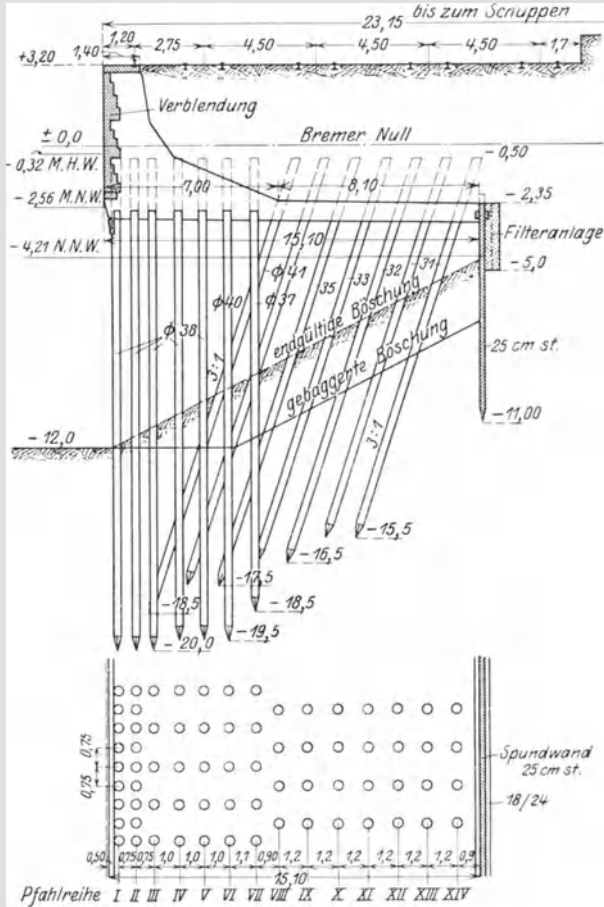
a u. b. Ufermauer in Bremen, Schnitt und Grundriß. Maßstab 1 : 300.
